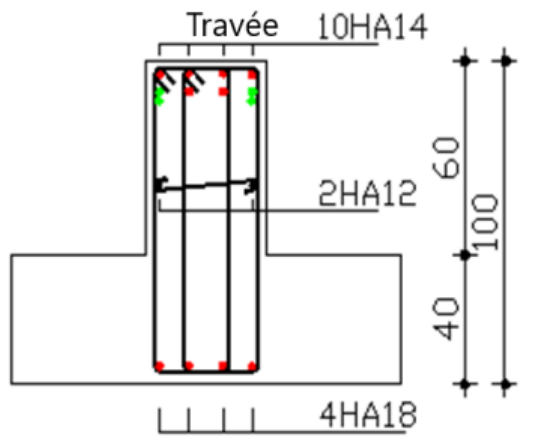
Ferrailage de la poutre secondaire en travée
